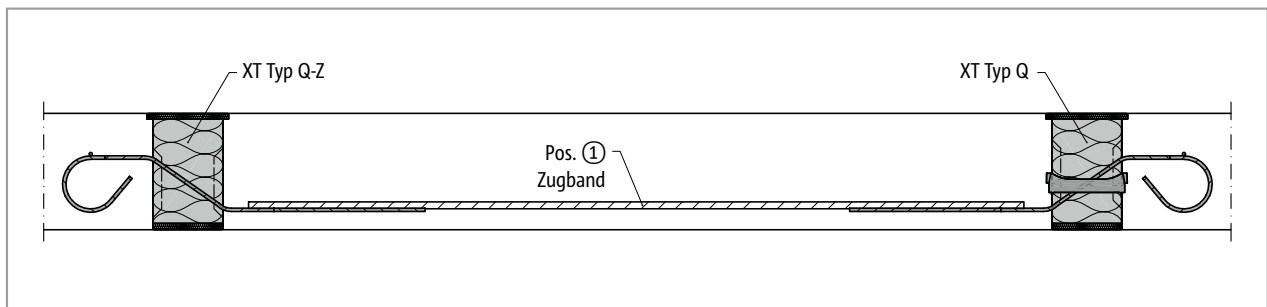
Schöck Isokorb® XT Typ Q-Z-V1 bis Q-Z-V4, Q-V1 bis Q-V4: Schnitt A-A; einachsig gespannte Stahlbetonplatte
